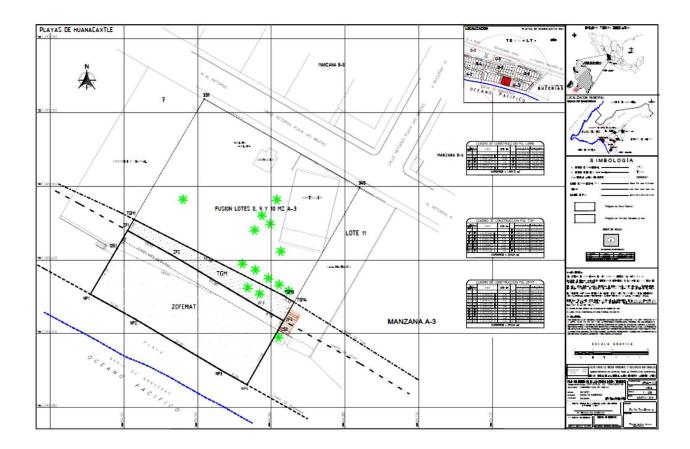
Plano topográfico del proyecto "Condominio Casa del Mar".
